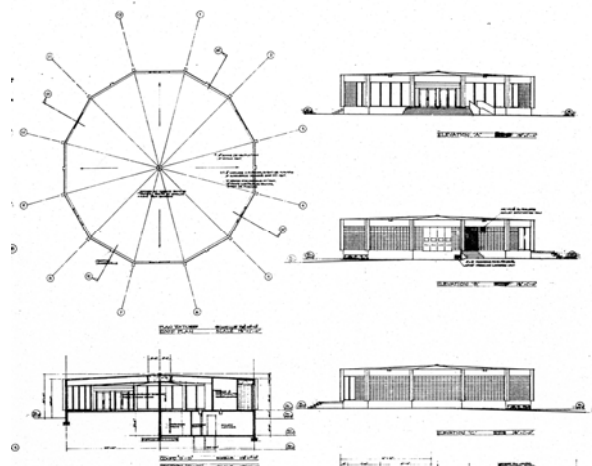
Plan et élévations du Service Bancaire, île Verte (1966)
